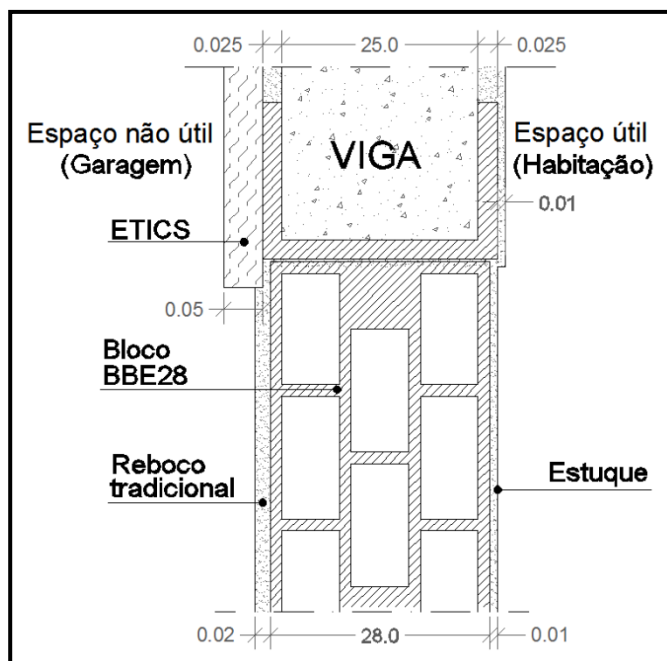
Pormenor da parede e viga de separação entre espaços úteis e não úteis, em corte (Pi1 e PTPi1)
